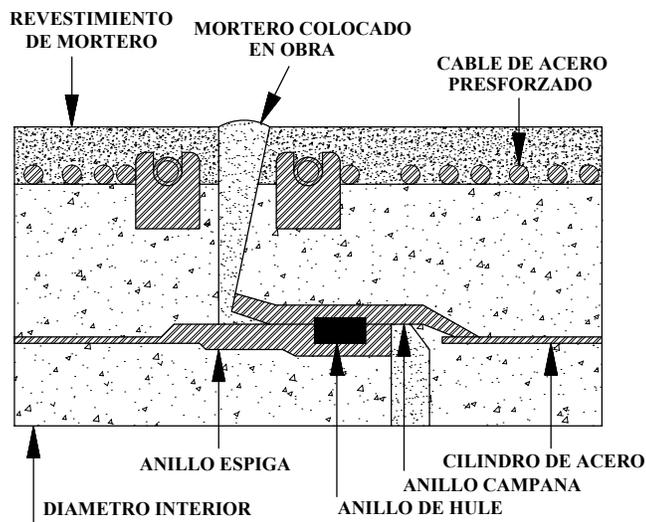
Unión espiga-campana en tuberías de concreto con cilindro de acero
